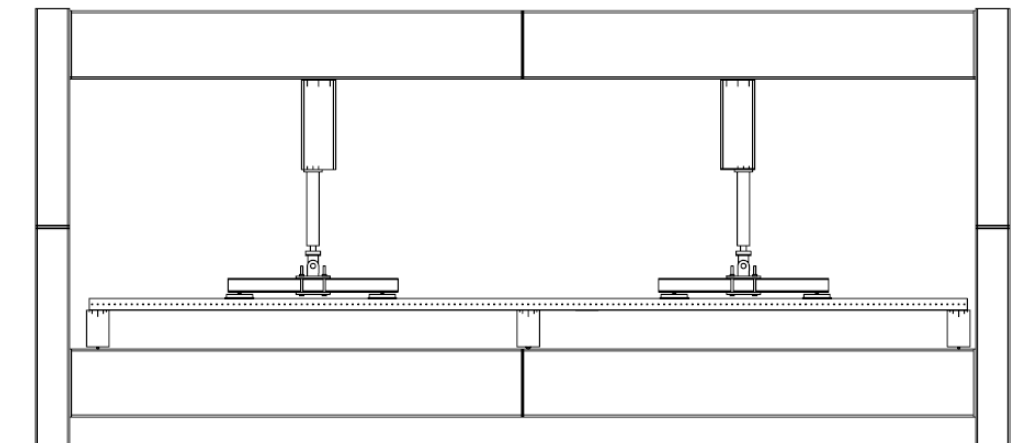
Dispositivo tipo de ensaio - II Fase de Ensaio.
